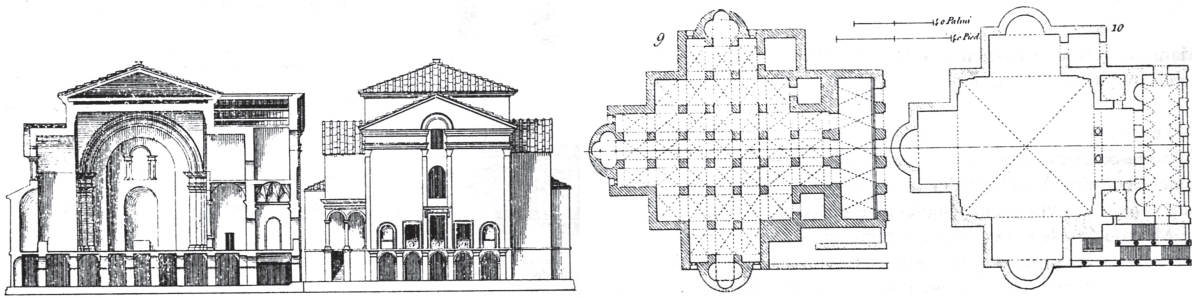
Le « cubisme » de San Sebastiano en plan, coupe, élévation
